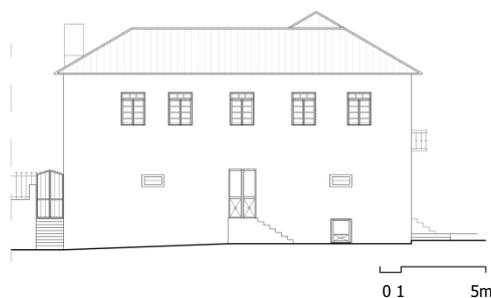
VISTA DO TERRENO PARA A FACHADA LATERAL
